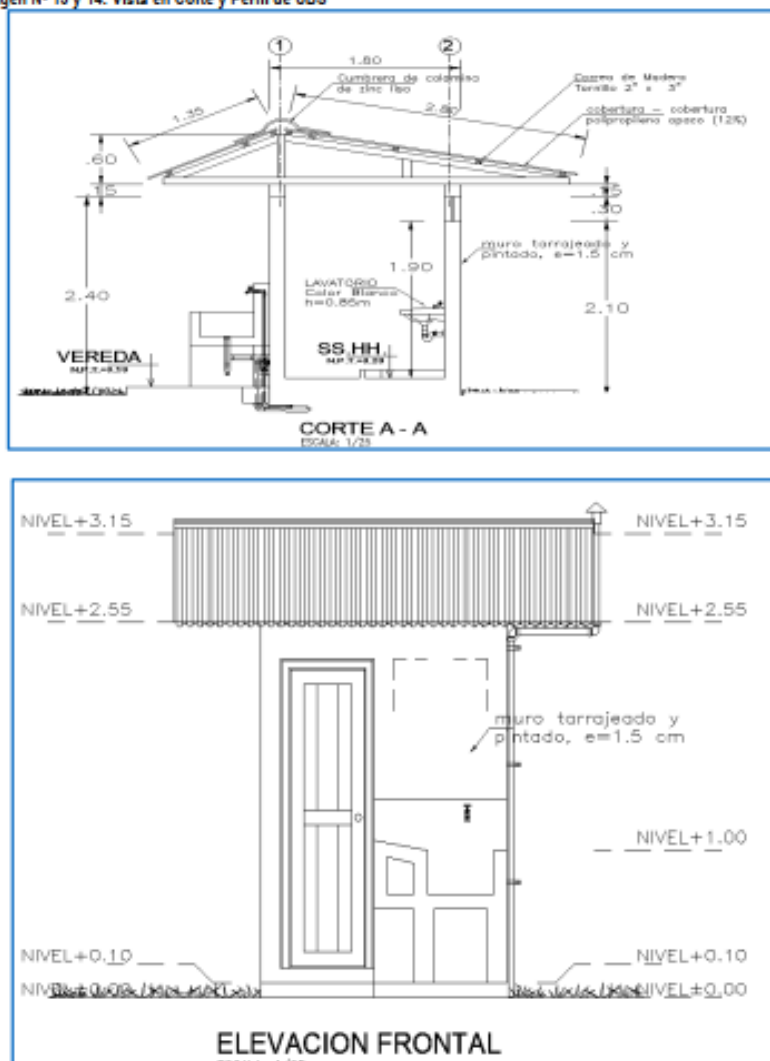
y 14: Vista en Corte y Perfil de UBS
